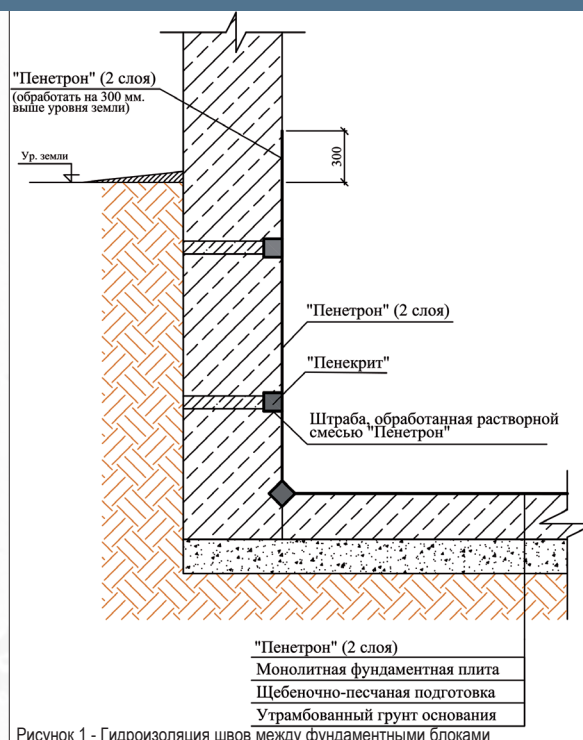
Гидроизоляция швов между фундаментными блоками
